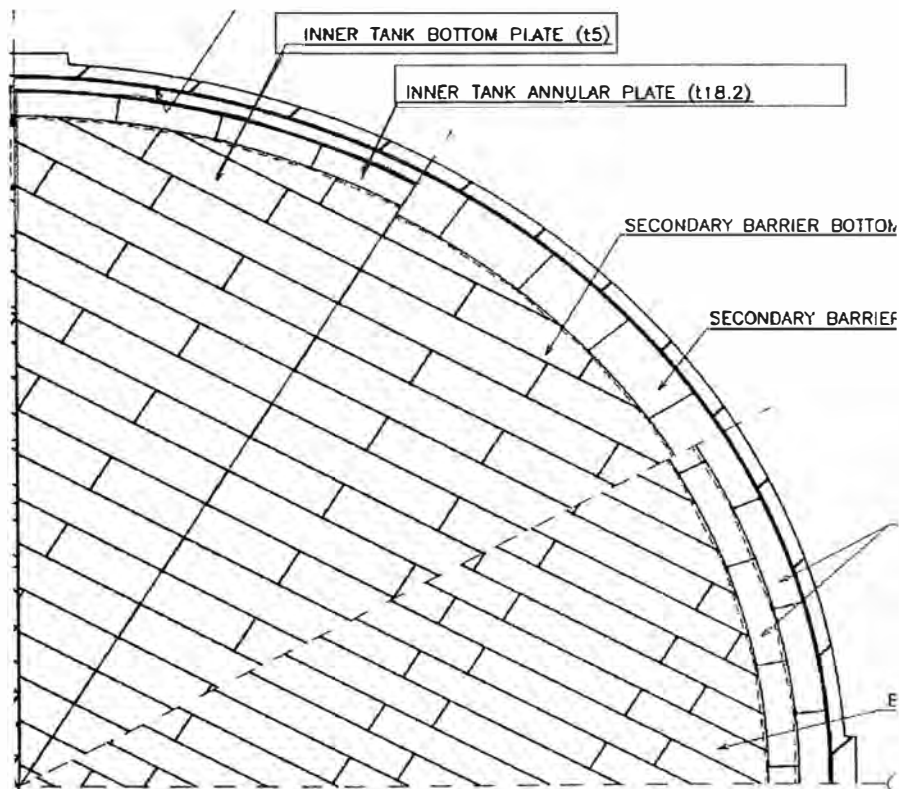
VISTA FONDO INTERNO Y ANILLO
